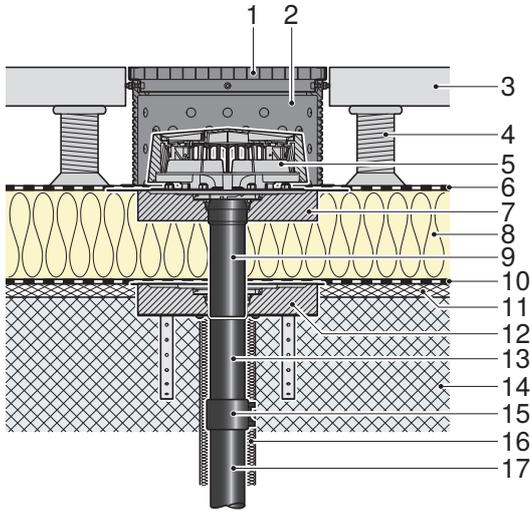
Монтаж на изолированной жесткой кровле с пароизоляцией и кровельным покрытием, подходящим для передвижения транспортных средств
